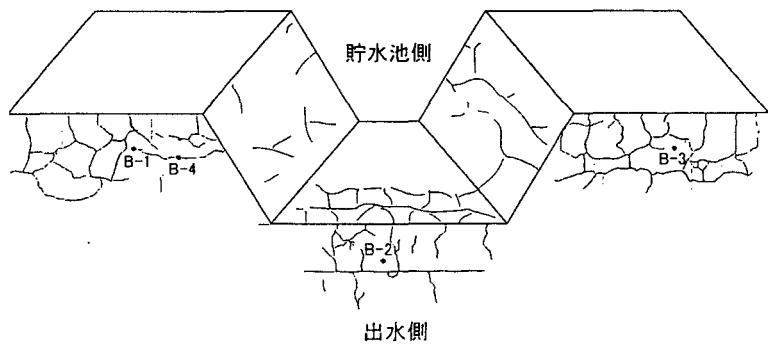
堤体のひび割れ状況と採取コアの位置
